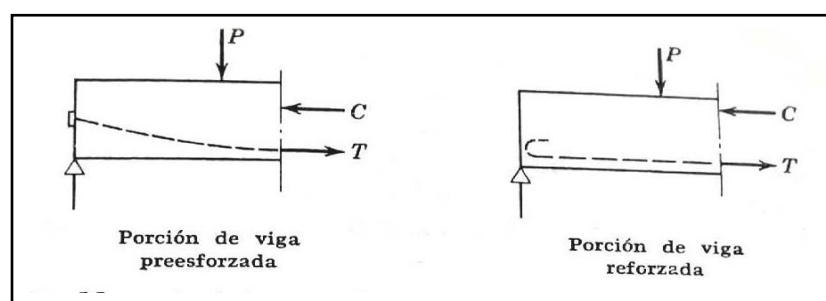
Momento interno resistente en vigas de concreto presforzado y reforzado.
